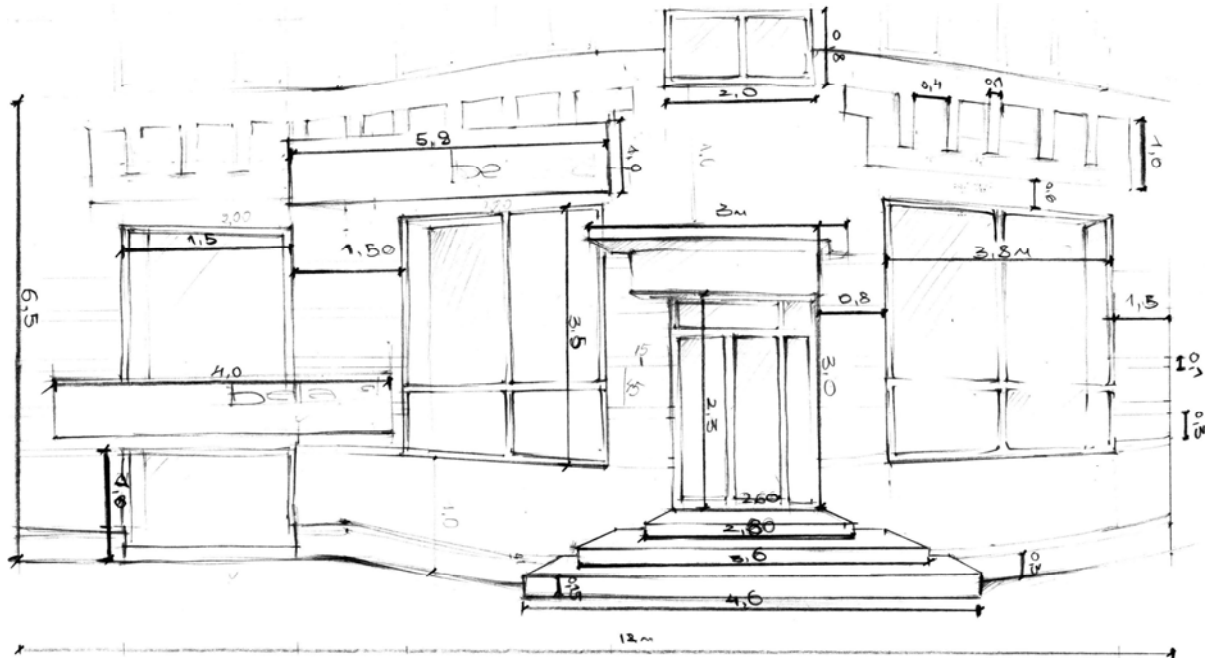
Фрагмент фасаду з входом у громадську будівлю
